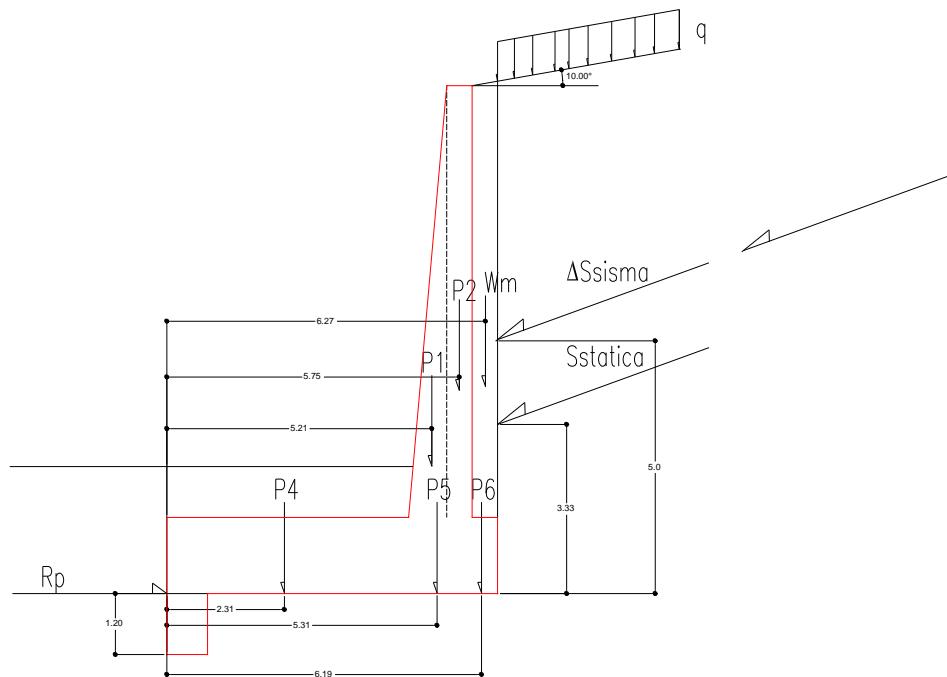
Carpenteria tipo A : Schema delle azioni agenti sul muro
